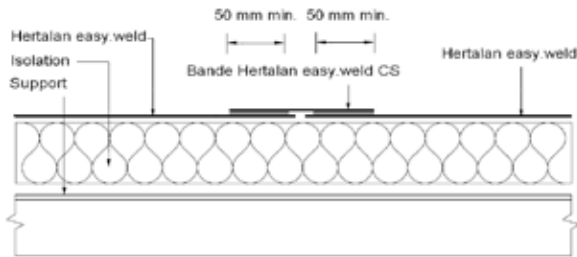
Assemblage transversal Hertalan easy.weld (MF)
